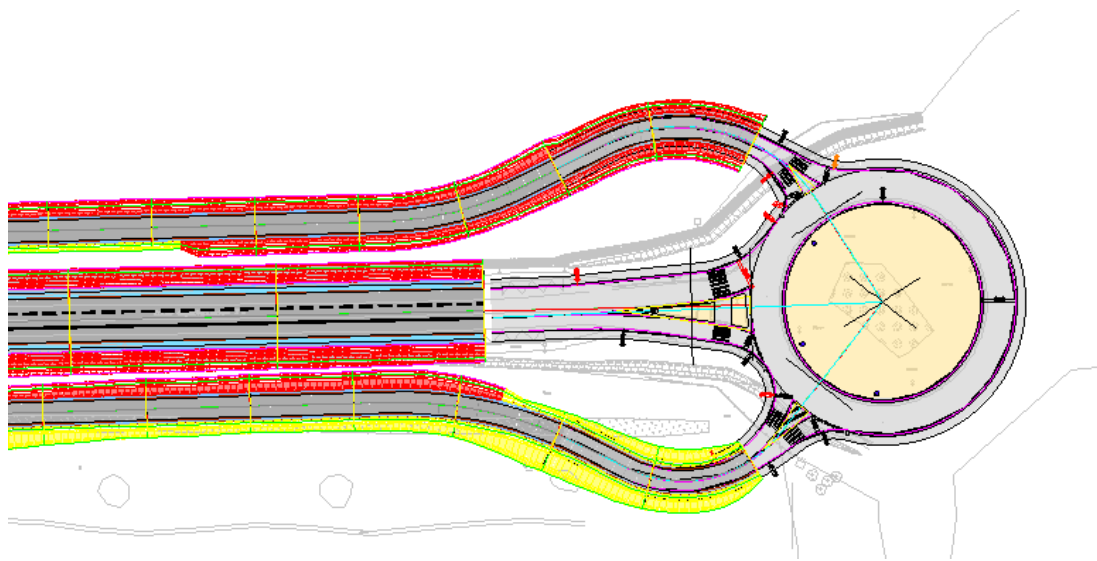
plan de détail de la sortie du giratoire des Fontenelles à 2 voies
